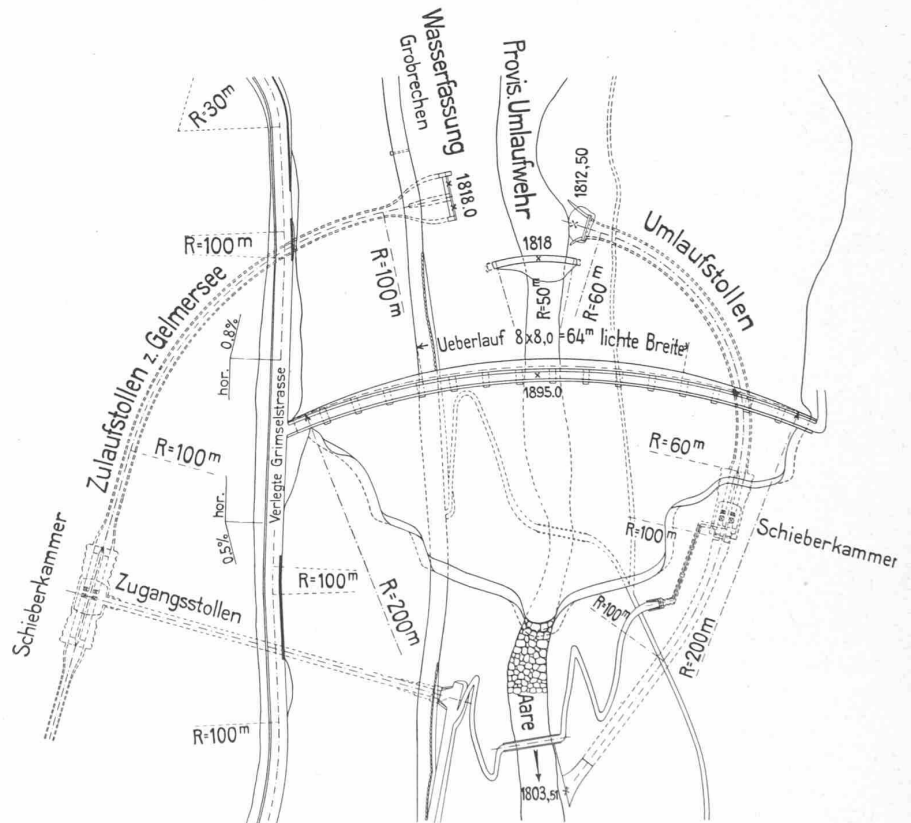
Lageplan der Grimselsperre. — Masstab 1 : 2000.
